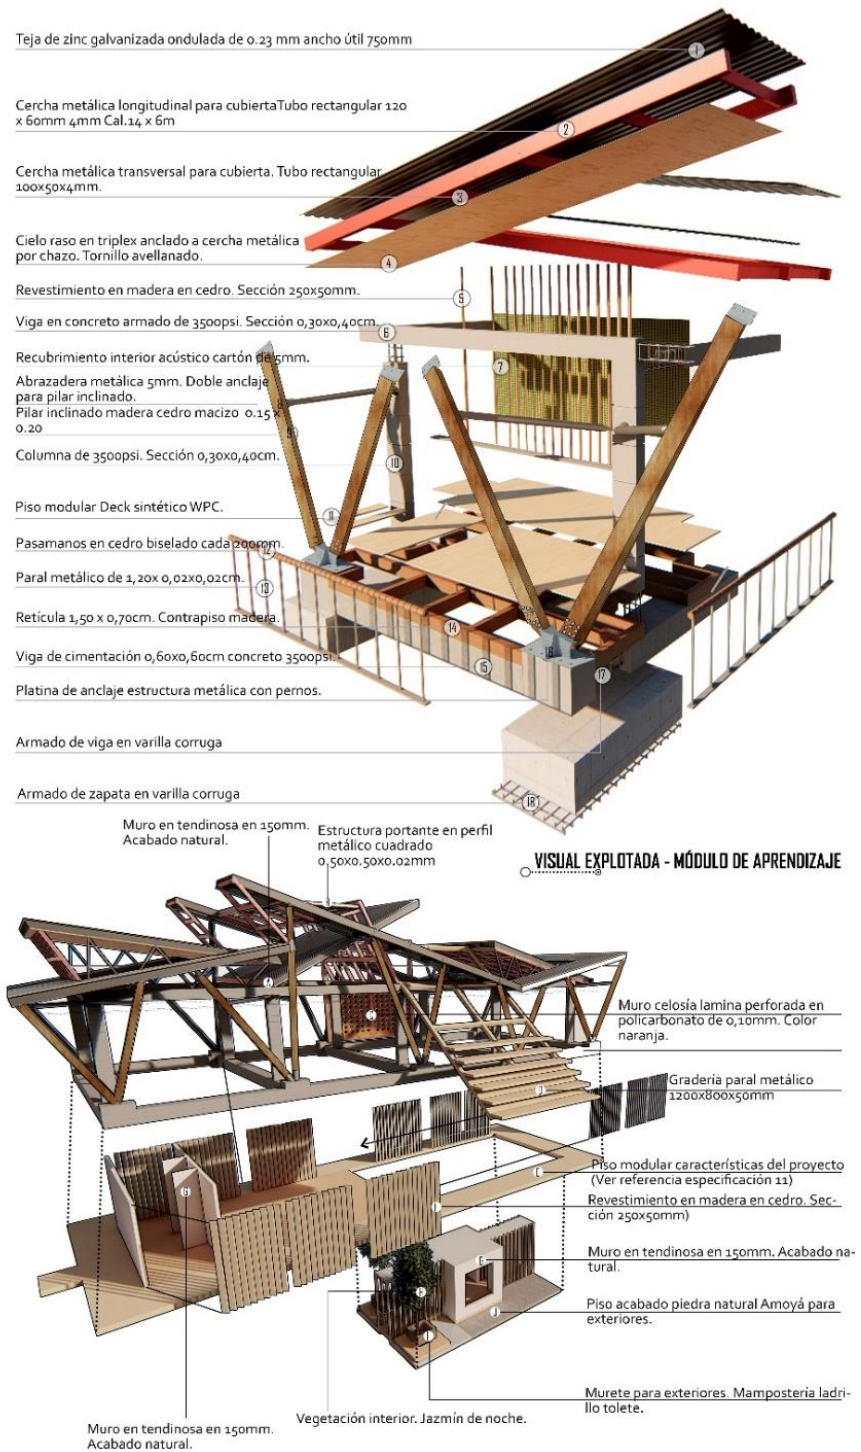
Isométrico explotado de propuesta. Sección estructural del módulo constructivo del equipamiento, identificando la materialidad propuesta ensamble general de diseño estructural. Elaboración propia.
